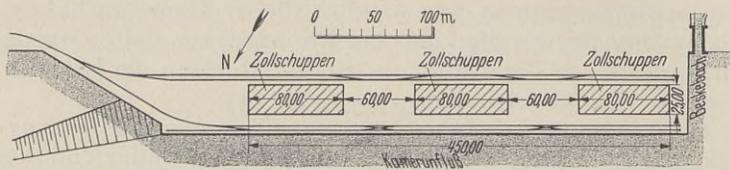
Lageplan der geplanten Kaimauer für Seeschiffe. (Reichskolonialamt.)
